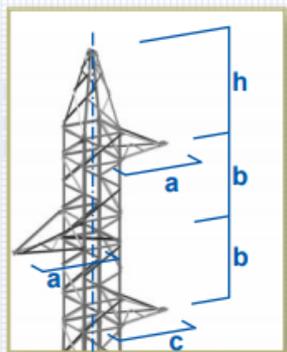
Detalla constructivo apoyo de celosía con armado tipo "S"
